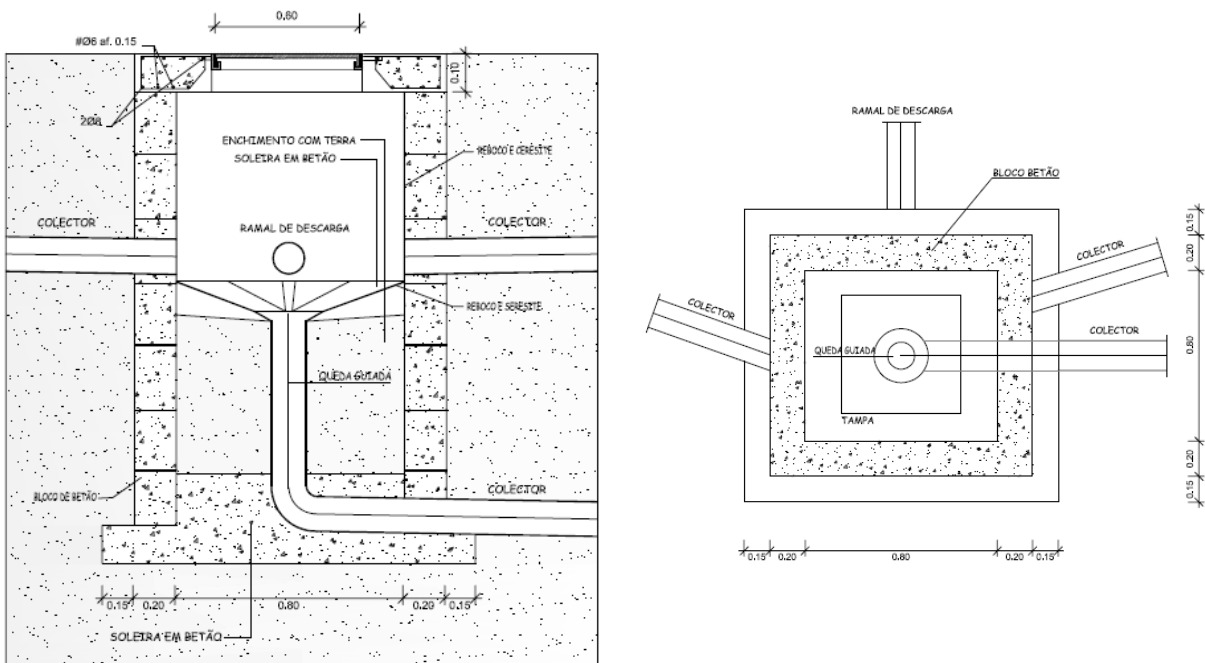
Câmara ramal de ligação – Corte tipo.
